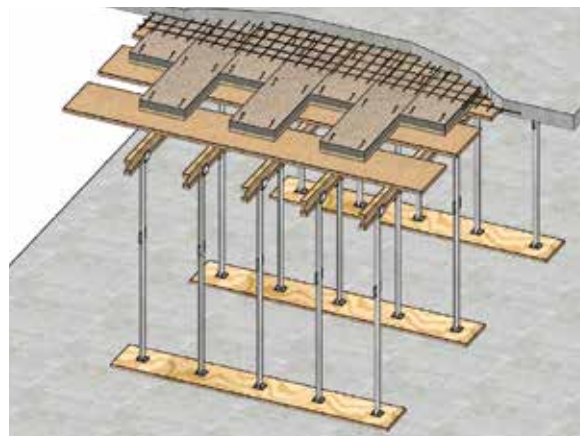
Mise en place des panneaux en coffrage isolant traditionnel
